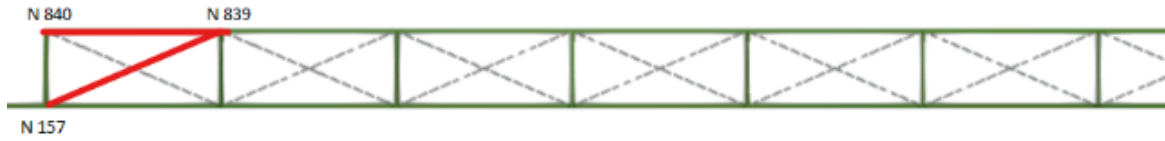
Elementos más significativos de la viga “durmiente” (Nivel +12.058 metros)
